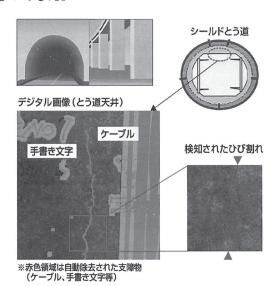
コンクリート構造物ひび割れ検知ソフト
